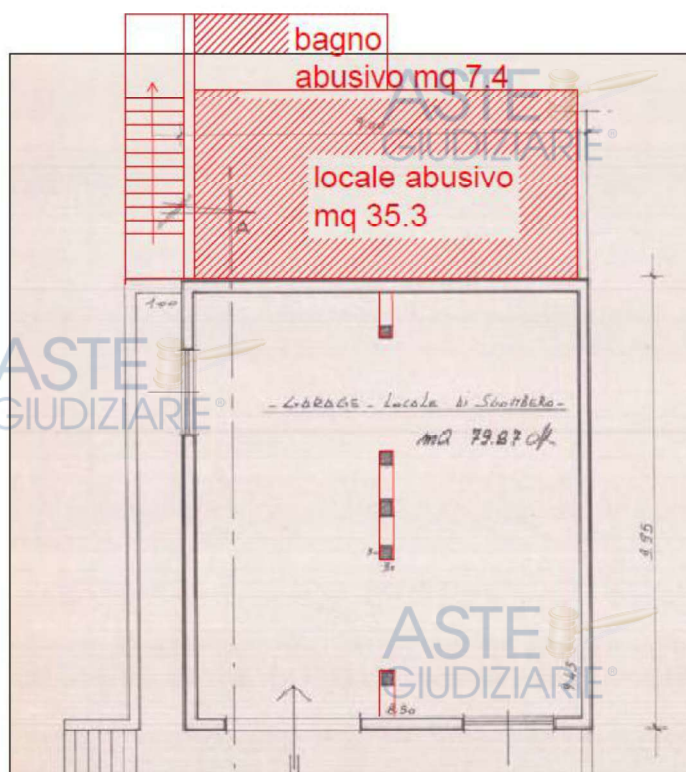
planimetria del Piano Seminterrato con l'evidenza degli abusi
